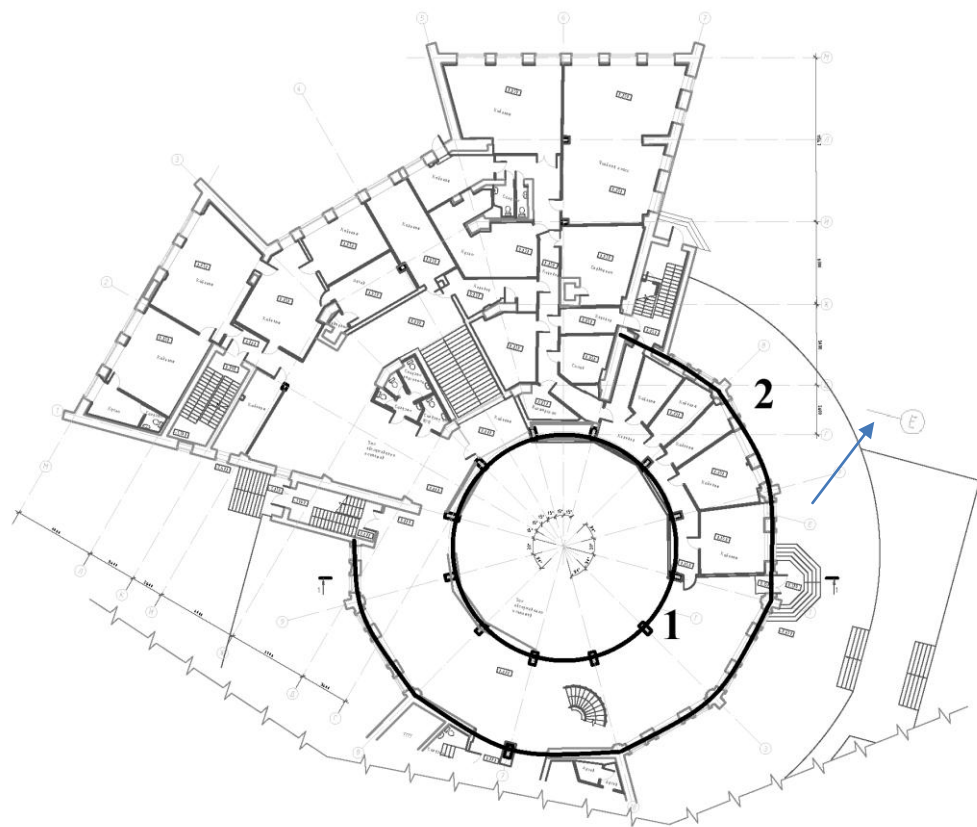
План 1-го этажа (до реконструкции): 1 – «внутреннее» кольцо, 2 – «внешнее» кольцо.
